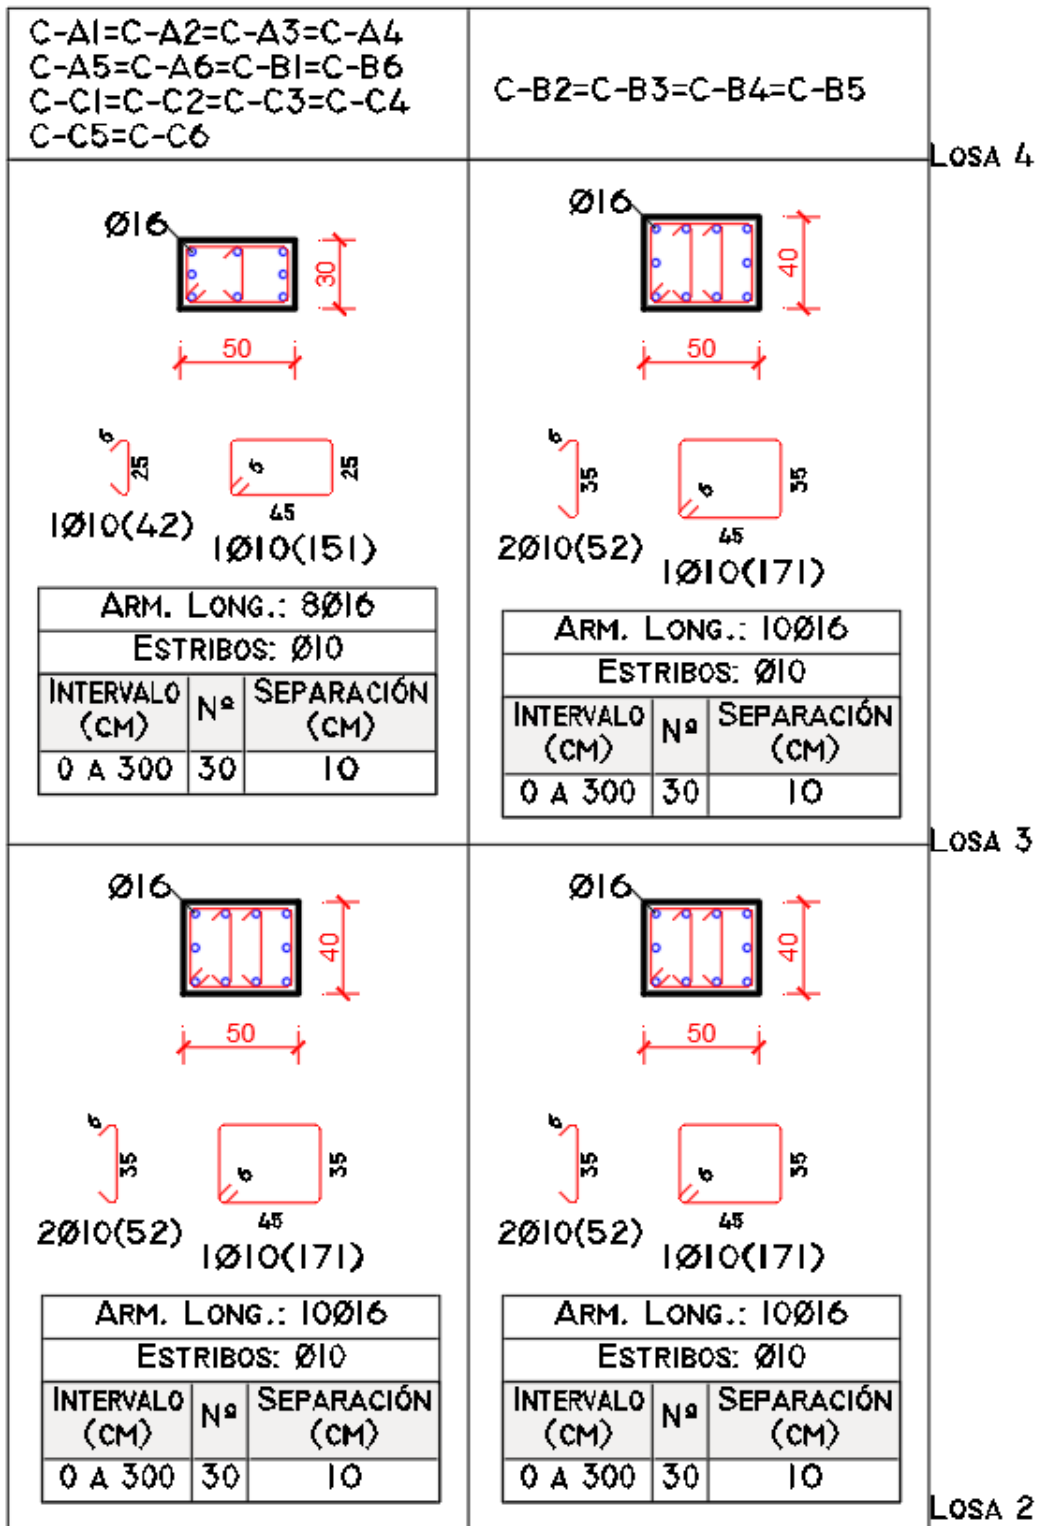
Detalle de Refuerzo Columnas, de Losa 2 a Losa 4, Estructura [7N-CS].
